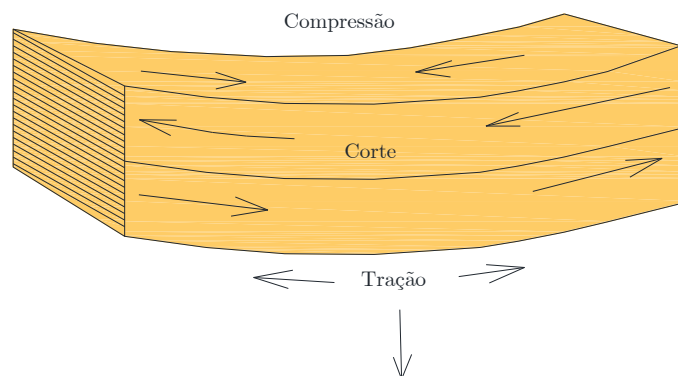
Flexão do elemento de madeira [Adaptado (Ritter;, Junior;, & Barardi;, 1990b)].
